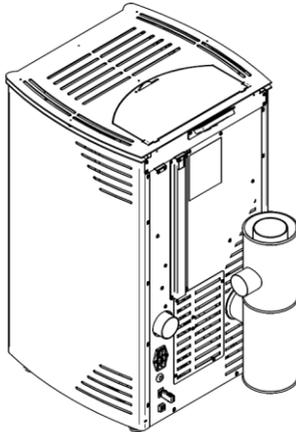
Vista lateral da instalação com chaminé, com exemplo do ponto de inspeção
